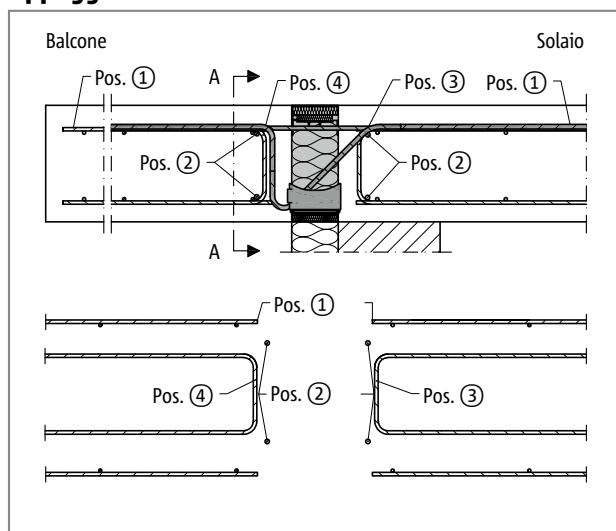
Schöck Isokorb® T tipo KL: armatura in opera con appoggio diretto
